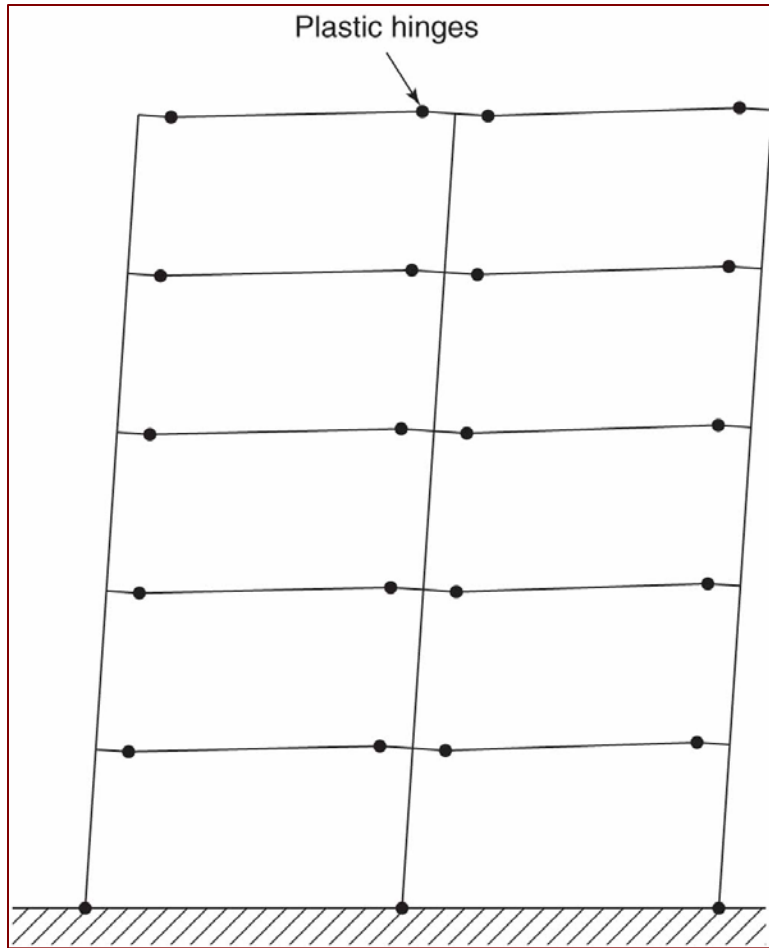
Comportamiento de columna fuerte – viga débil.
